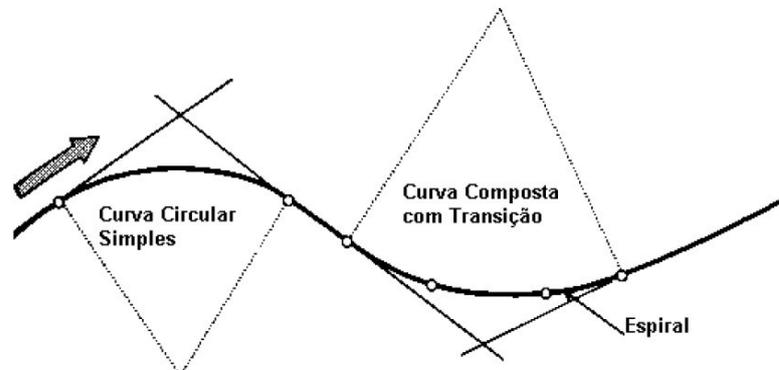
PLANTA BAIXA DE UMA RODOVIA
